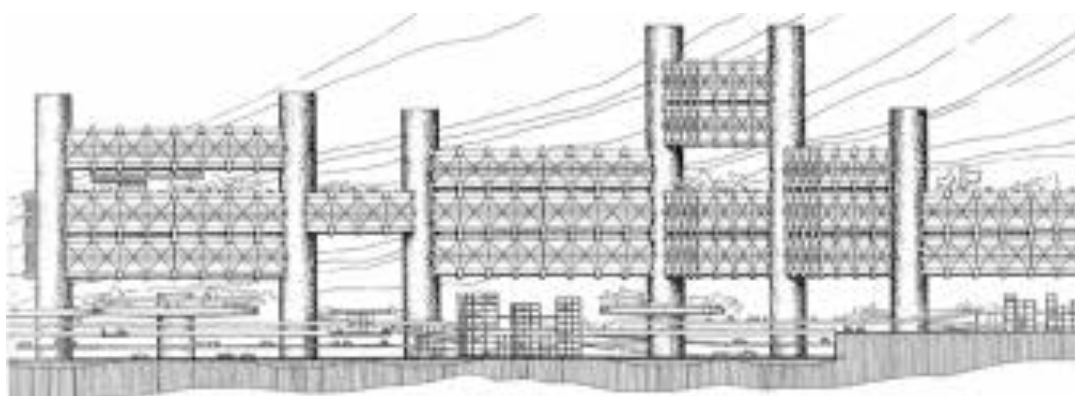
Shinkuko Project: City in the Air (elevation plan: employing the joint core system), Arata Isozaki, 1960
